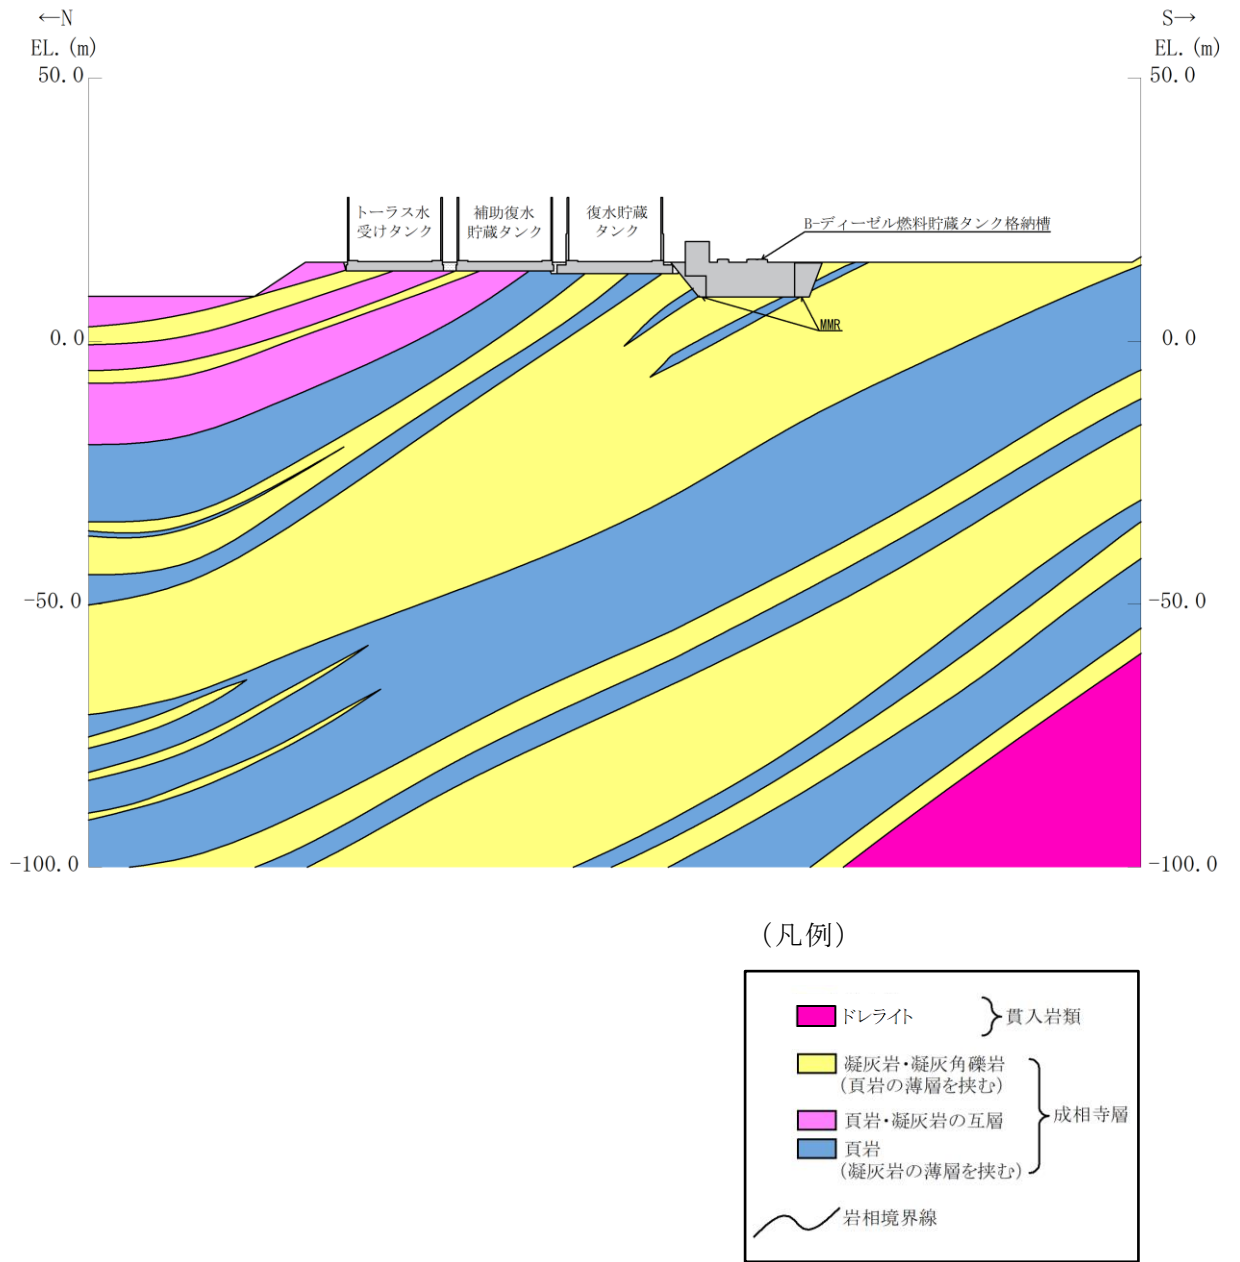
復水貯蔵タンク遮蔽壁の評価対象断面図 (A-A 断面)
